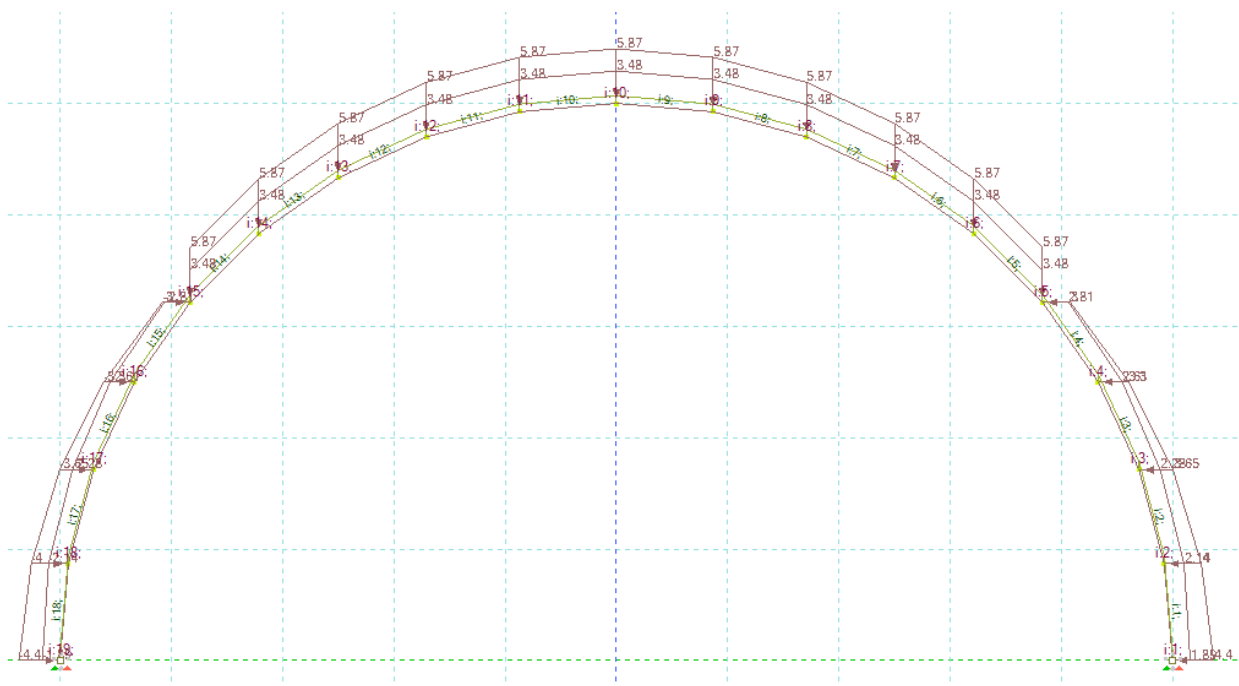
Нагрузки на расчётную схему в ПК «ЛИРА» версии 10.12
